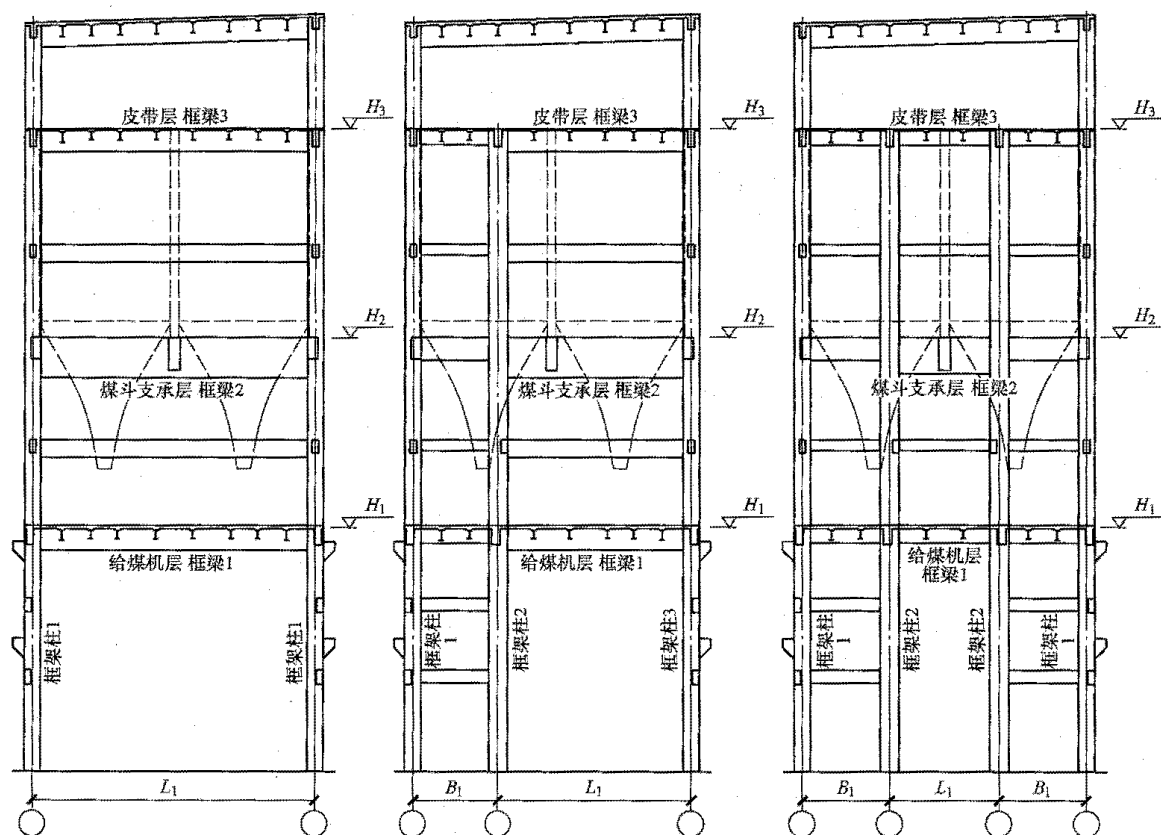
钢筋混凝土结构侧煤仓间布置示意图
